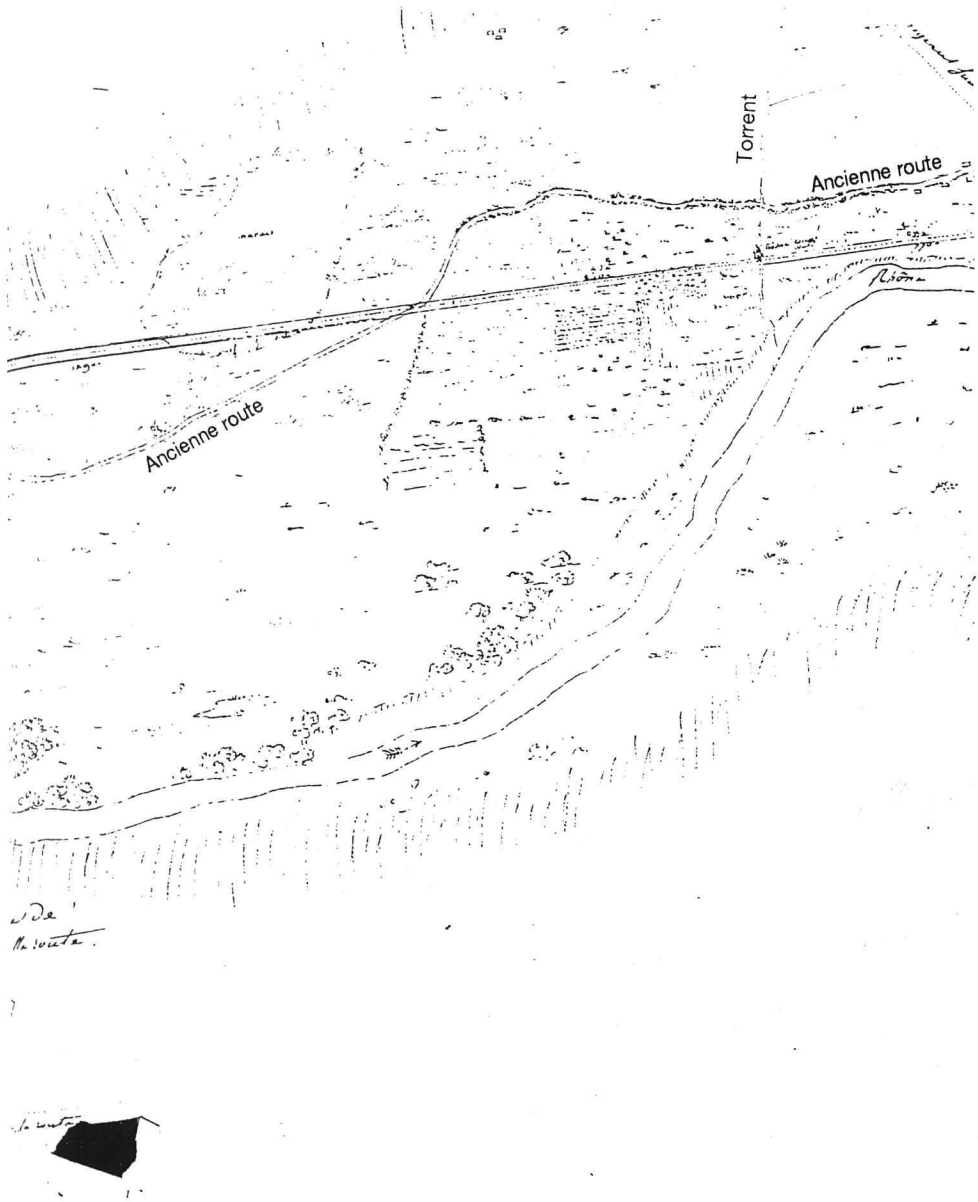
Plan von Ignaz Venetz (um 1820), der den Ausbau der Strasse bei Turtmann zur geraden Allee darstellt (StaV; DTP/Plans/Route 18)
